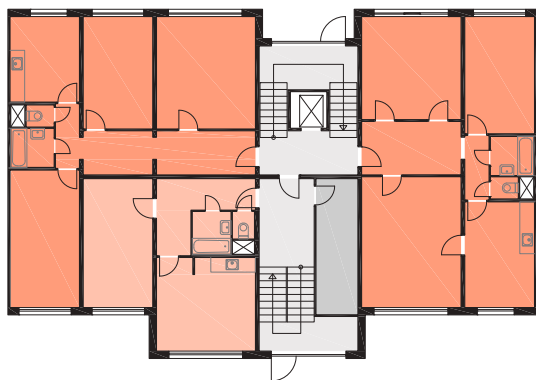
Konstrukční soustava OP 1.31 - Nový Jičín (Zdroj: panelaky.info)
